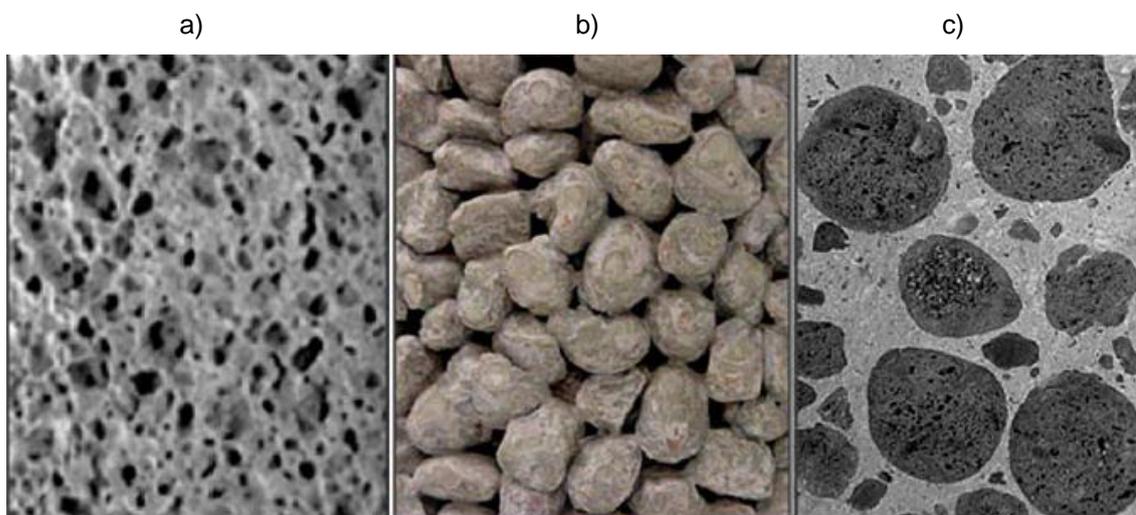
a) Concreto aerado. b) Concreto sem finos. c) Concreto leve estrutural.
